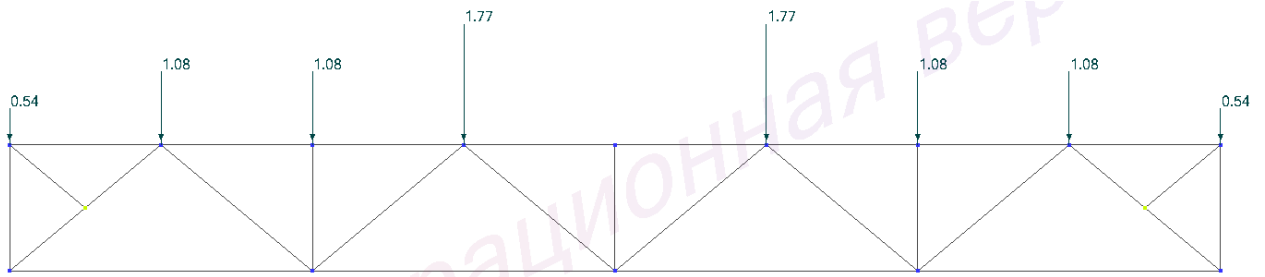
Нагрузки от конструкции покрытия (узловые), тс
